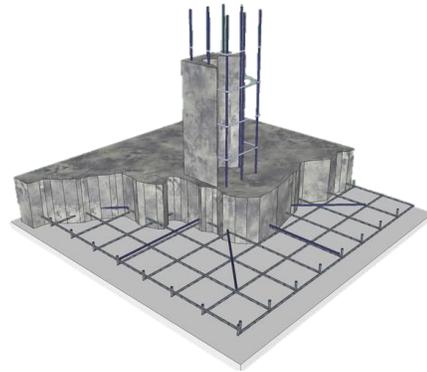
Zapata aislada de concreto armado. Tomado de civilparaelmundo.com (consultado el 14/11/2020)
